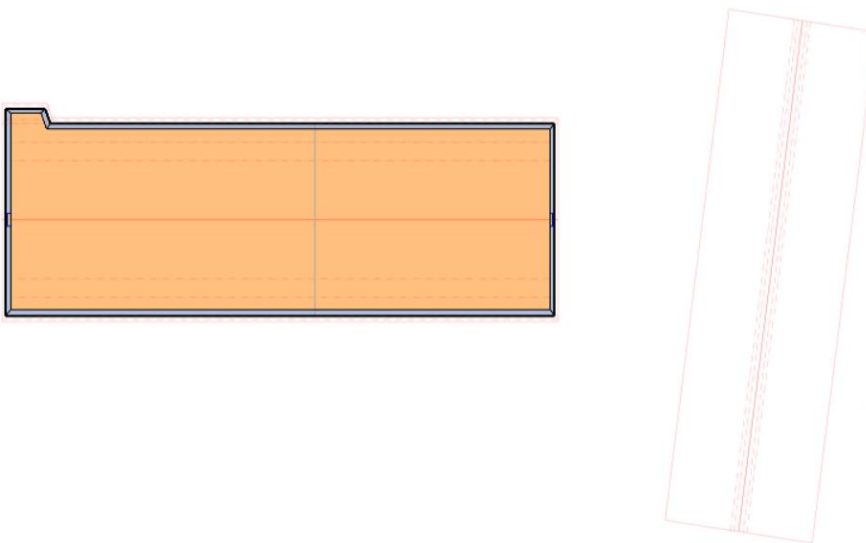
Grundriss Dachgeschoss, zoniert
